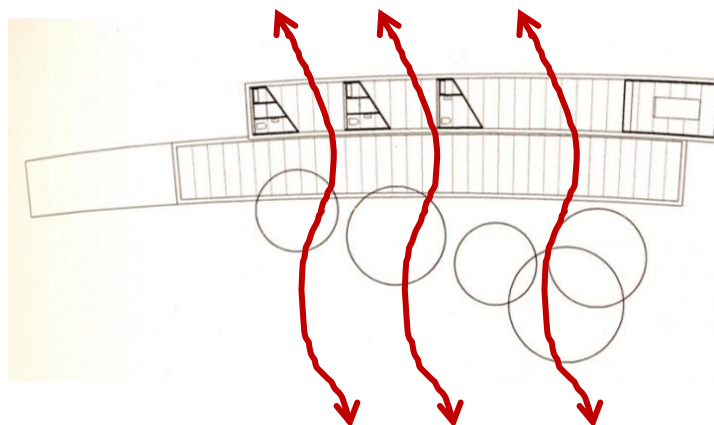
Planta del Pabellón del Baño Fuente: Ekain Jiménez Valencia, 2017
